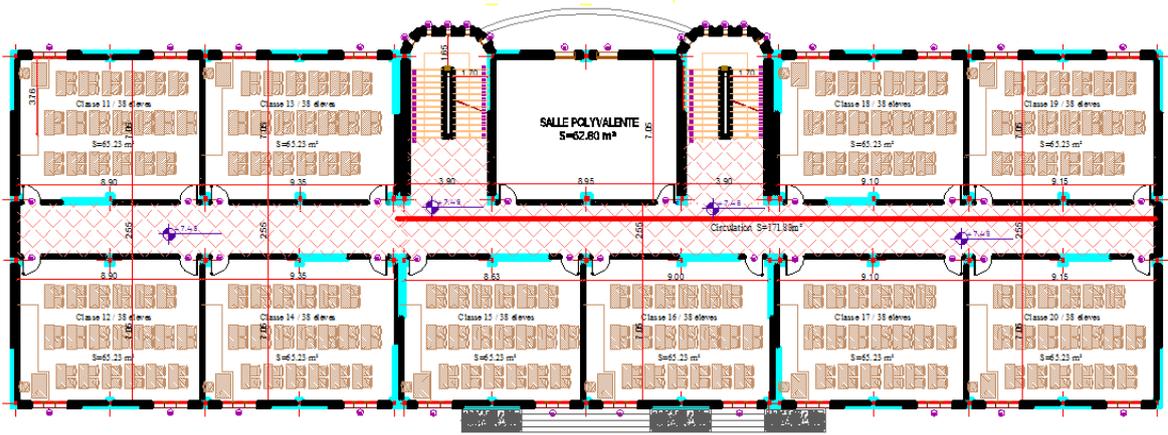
plan du 2<sup>er</sup> étage (source SARL ICARA)
